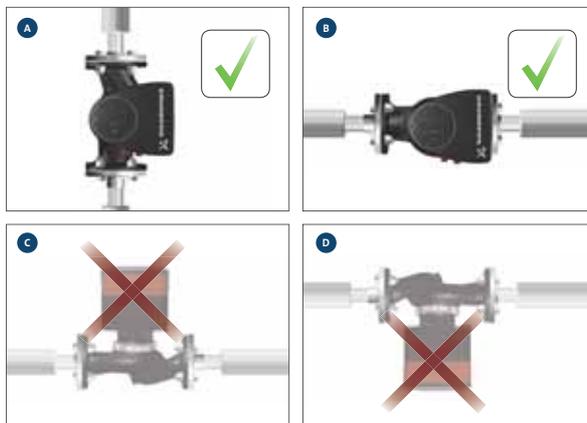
Eingebaute Pumpe mit Motorwelle in horizontaler Position
